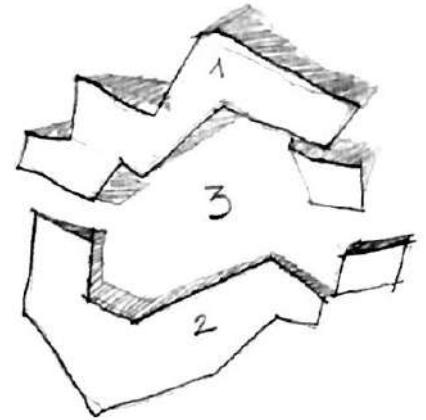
Planta de la iglesia con las tres naves\_elaboración propia
